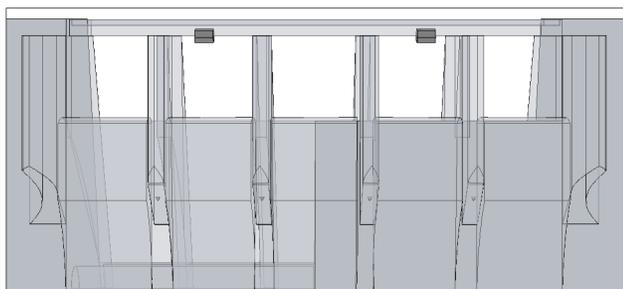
Pilas aguas arriba de la presa (Fuente: Elaboración propia).
